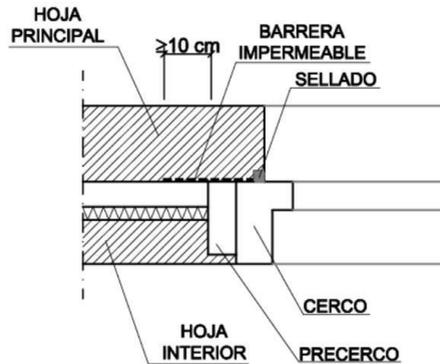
Encuentro fachada con carpintería. HS-Salubridad (CTE)
